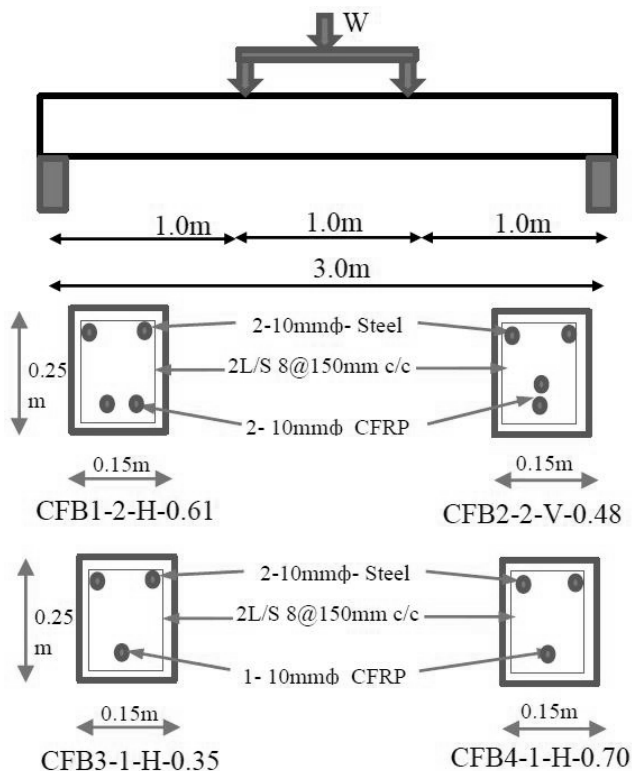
Конструкція та армування експериментальних залізобетонних балок
